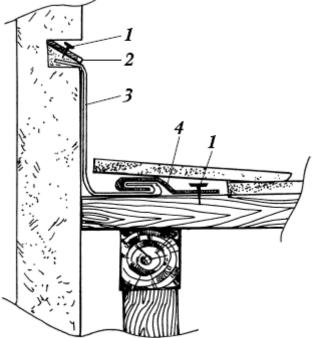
Заделка места примыкания кровли к продольной стене: 1) гвозди; 2) закладная рейка; 3) фартук из кровельной стали; 4) кляммер
